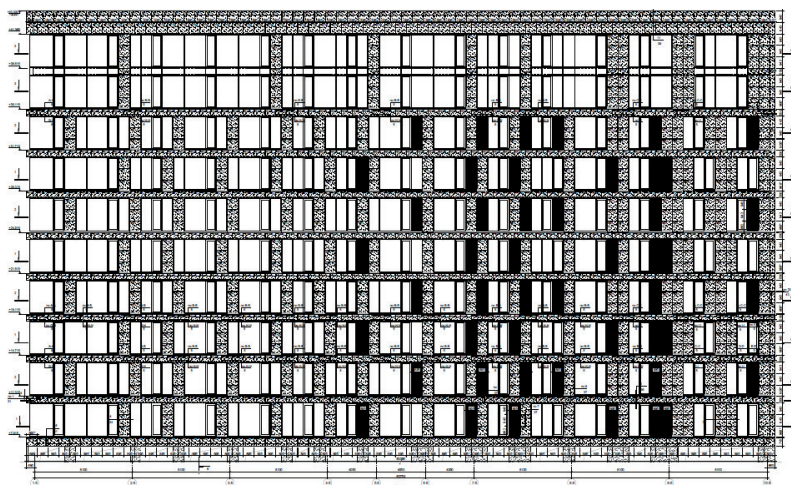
Фасад здания с «узкими» простенками с заполнением каркаса кладкой из ячеистобетонных блоков
